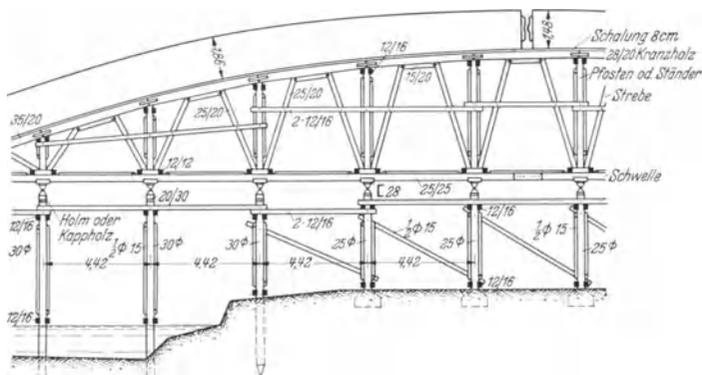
Lehrgerüst der Neckarbrücke Cannstatt.
